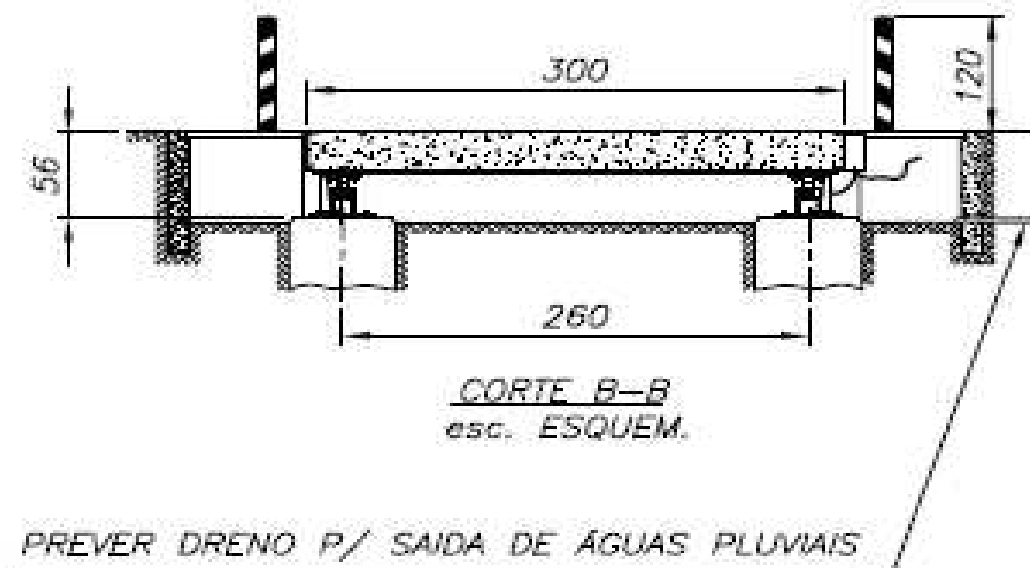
Corte transversal. Esquema de montagem de Balança Rodoviária nº 1 - Área Primária.
